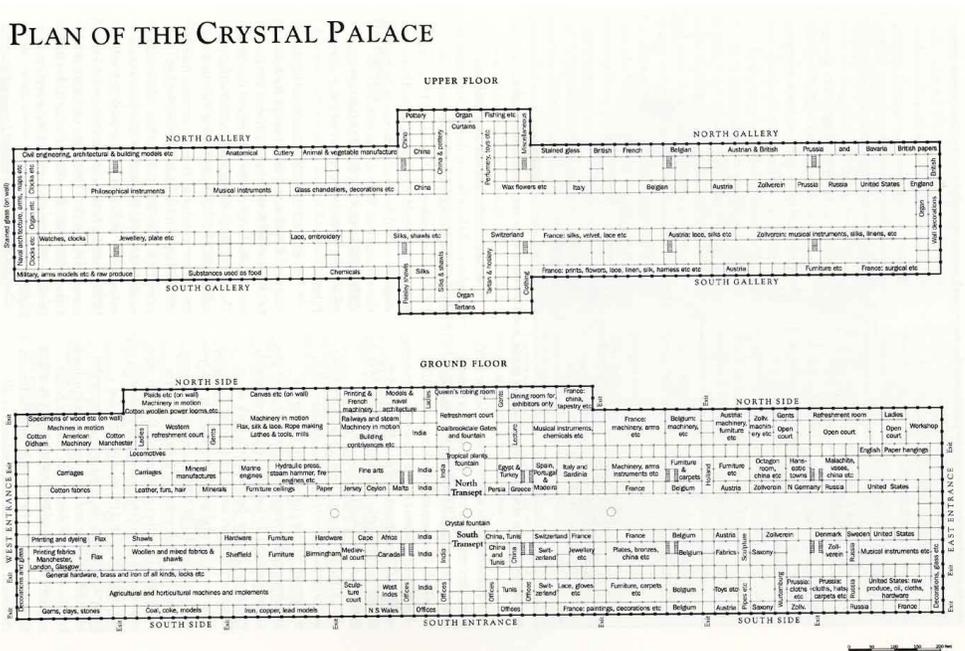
Planta baixa do *Crystal Palace*, 1851, Londres.
